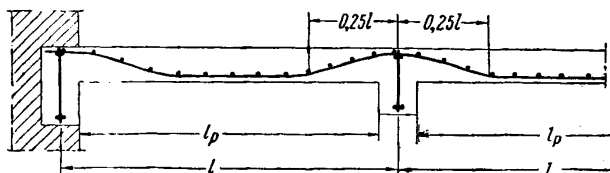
Армирование многопролетных балочных плит рулонными сетками с продольным расположением рабочих стержней
